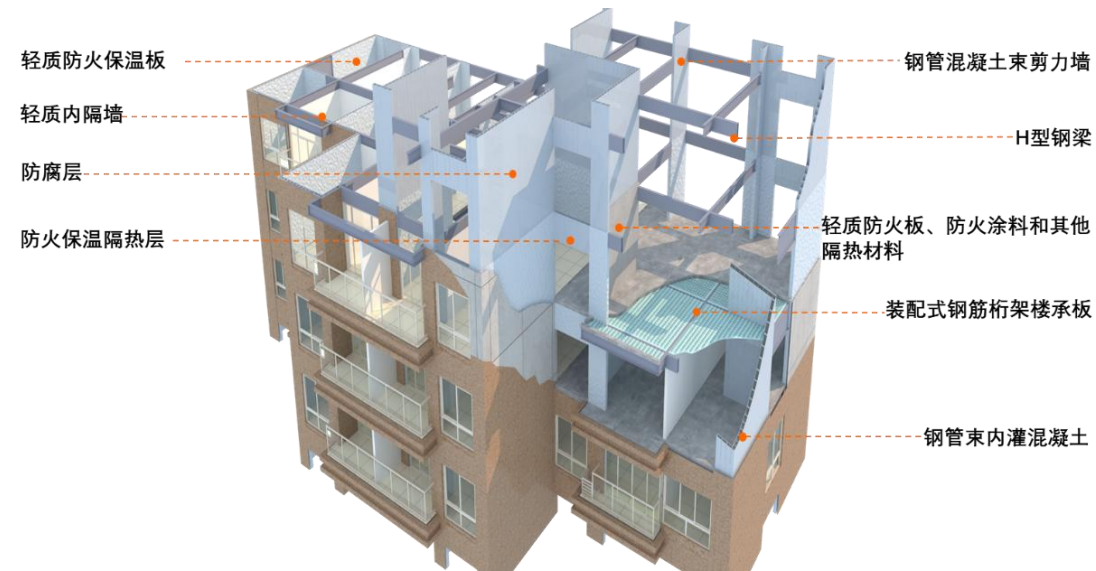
钢管混凝土束结构住宅建筑体系示意
